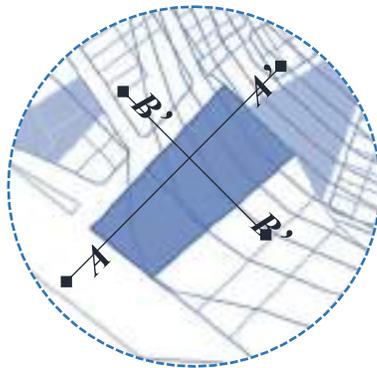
CORTE TRANSVERSAL B' - B'' Fuente: SAS planet, propia
